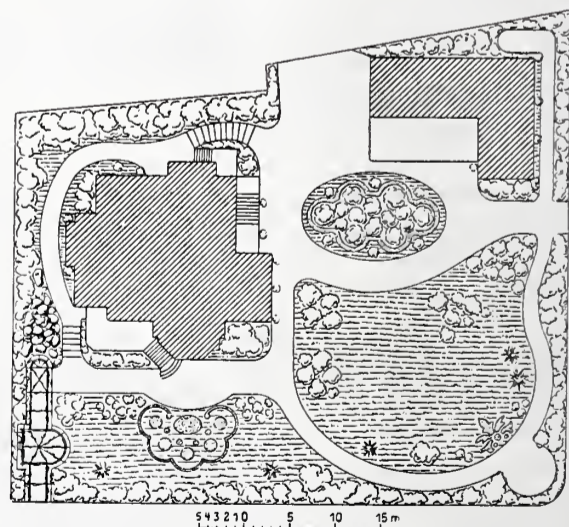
Lageplan der Villa Baumann in Zürich. Masstab 1 : 1000.
